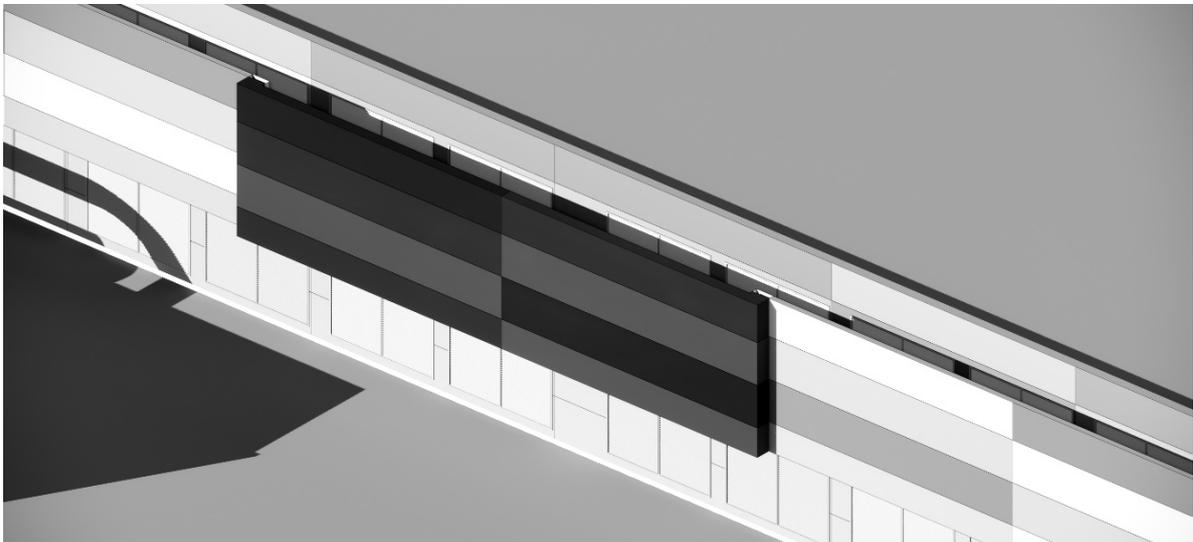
Concetto di interruzione facciate – Vista assonometrica
